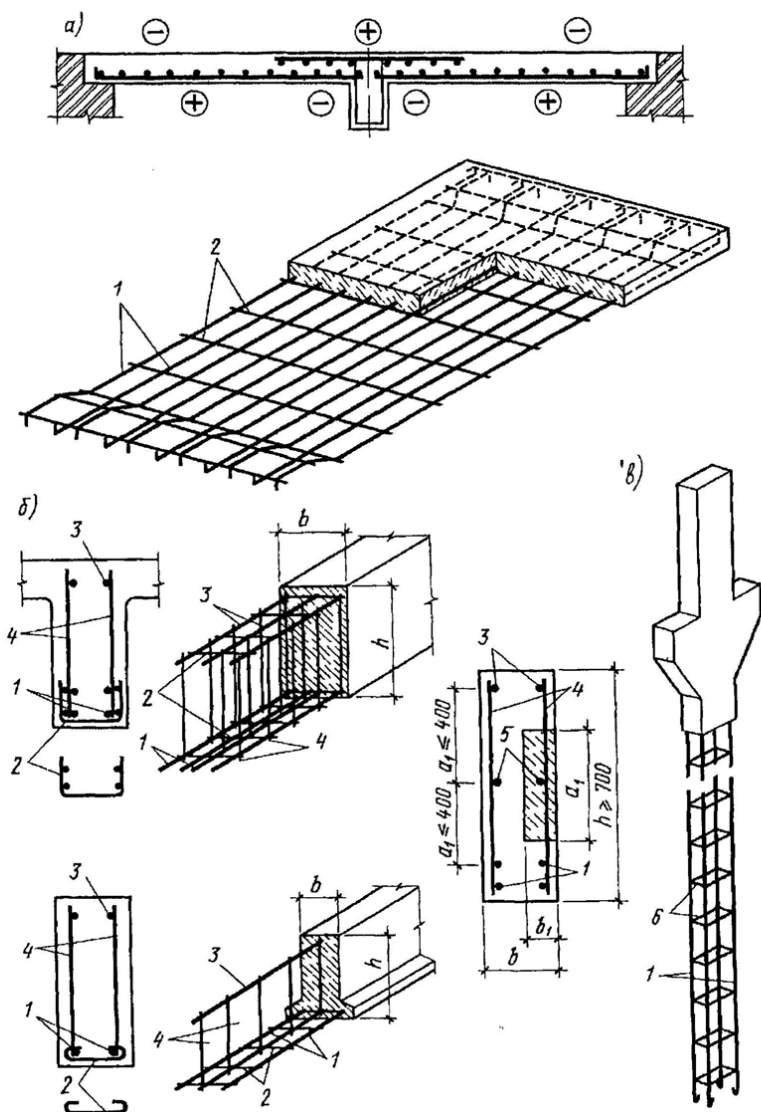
Армирование железобетонных элементов: *a* – плиты; *б* – балки; *в* – колонны; *1* – рабочая продольная арматура; *2* – конструктивная; *3* – монтажная; *4* – поперечная рабочая; *5* – конструктивная продольная; *б* – хомуты (поперечная арматура) колонн
